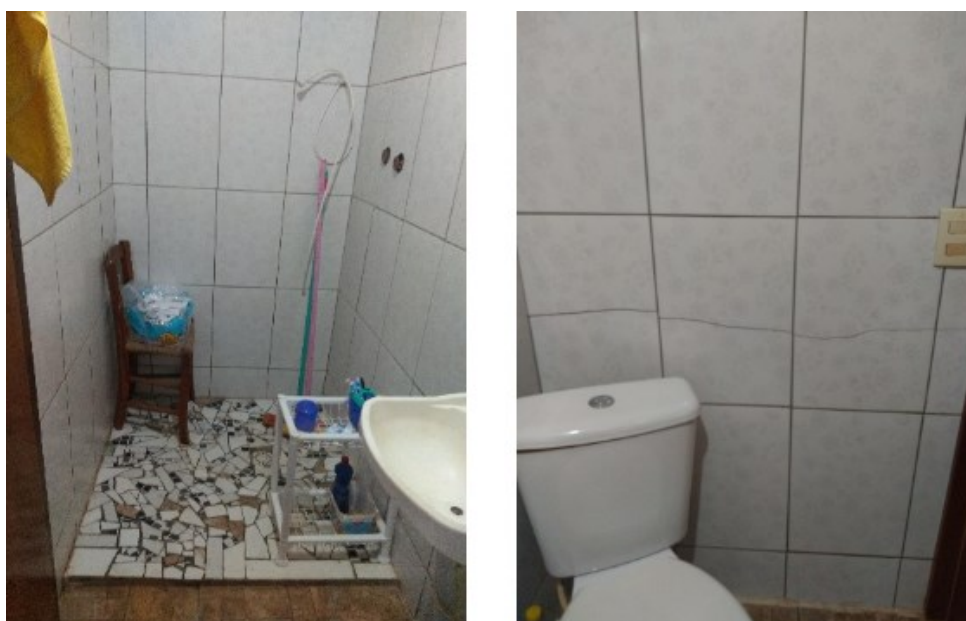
Banheiro construído com laje de concreto sobre estrutura de madeira acarretou em vazamentos por incompatibilidade dos materiais. O box foi inutilizado. Abaixamento da laje de concreto causou fissuras no revestimento (fotos de 2020)
